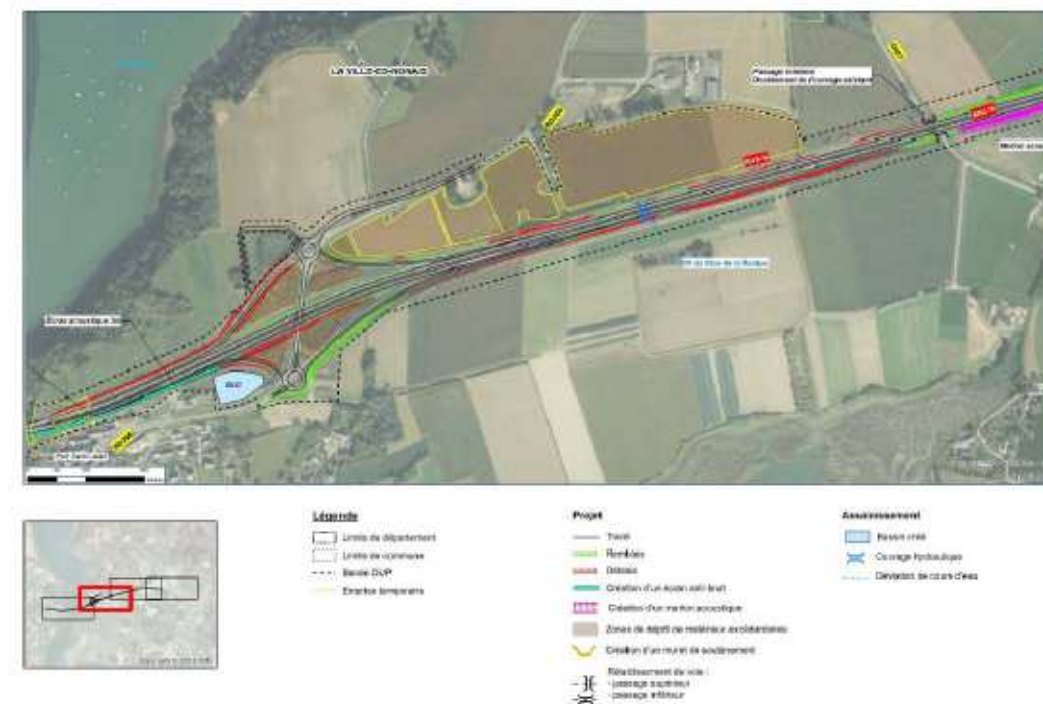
Plan général des travaux au niveau des RD 366 et RD 407 (source : dossier)
